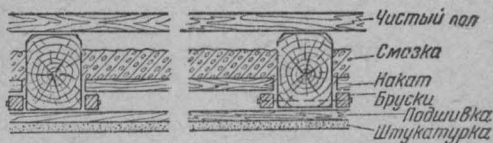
Междуэтажное перекрытие по деревянным балкам.
